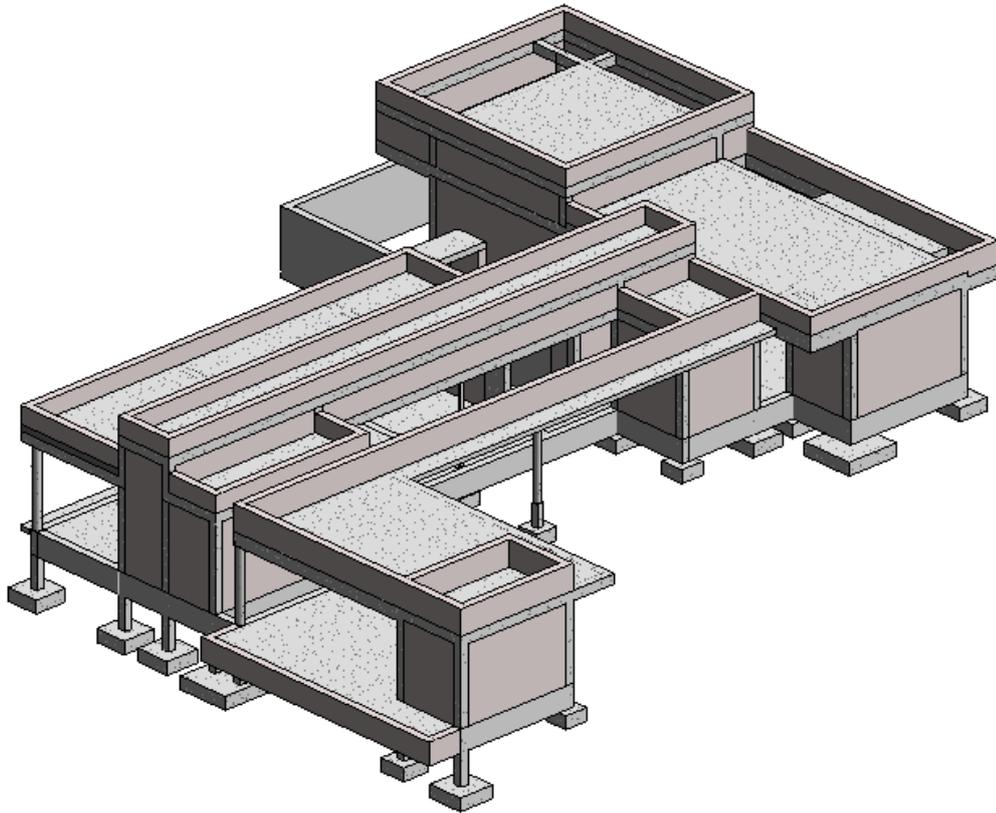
Elementos de fundação, vigas, lajes e paredes do projeto de execução, Revit
